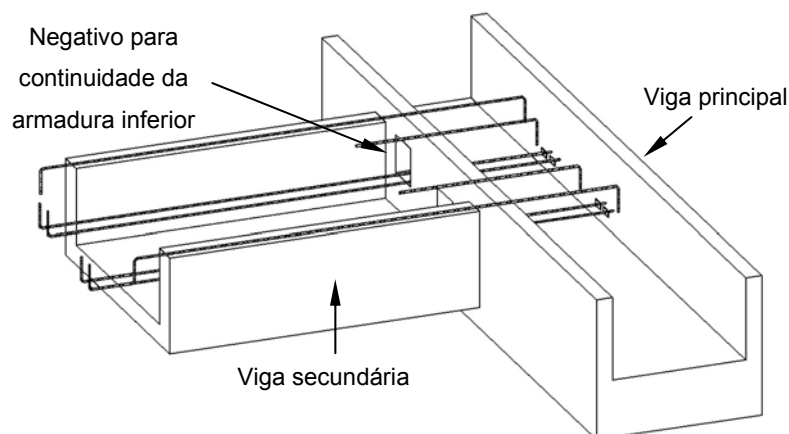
Ligação viga – viga entre uma viga principal e uma secundária
